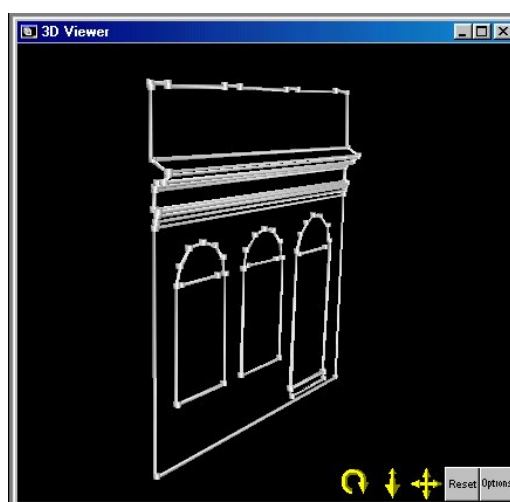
Modelo de linhas da fachada do imóvel nº 147.
